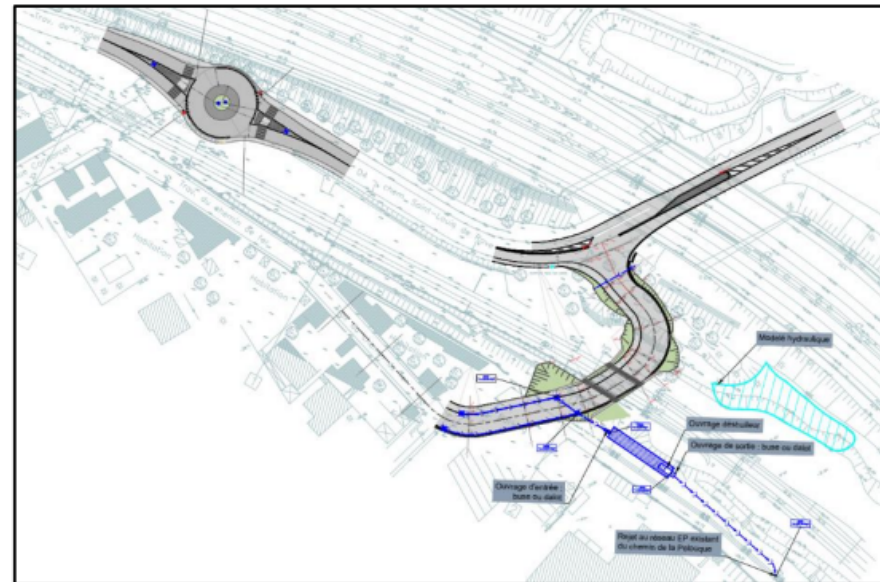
Vu en plan des aménagements sur la RD4 (Source : SETEC)
